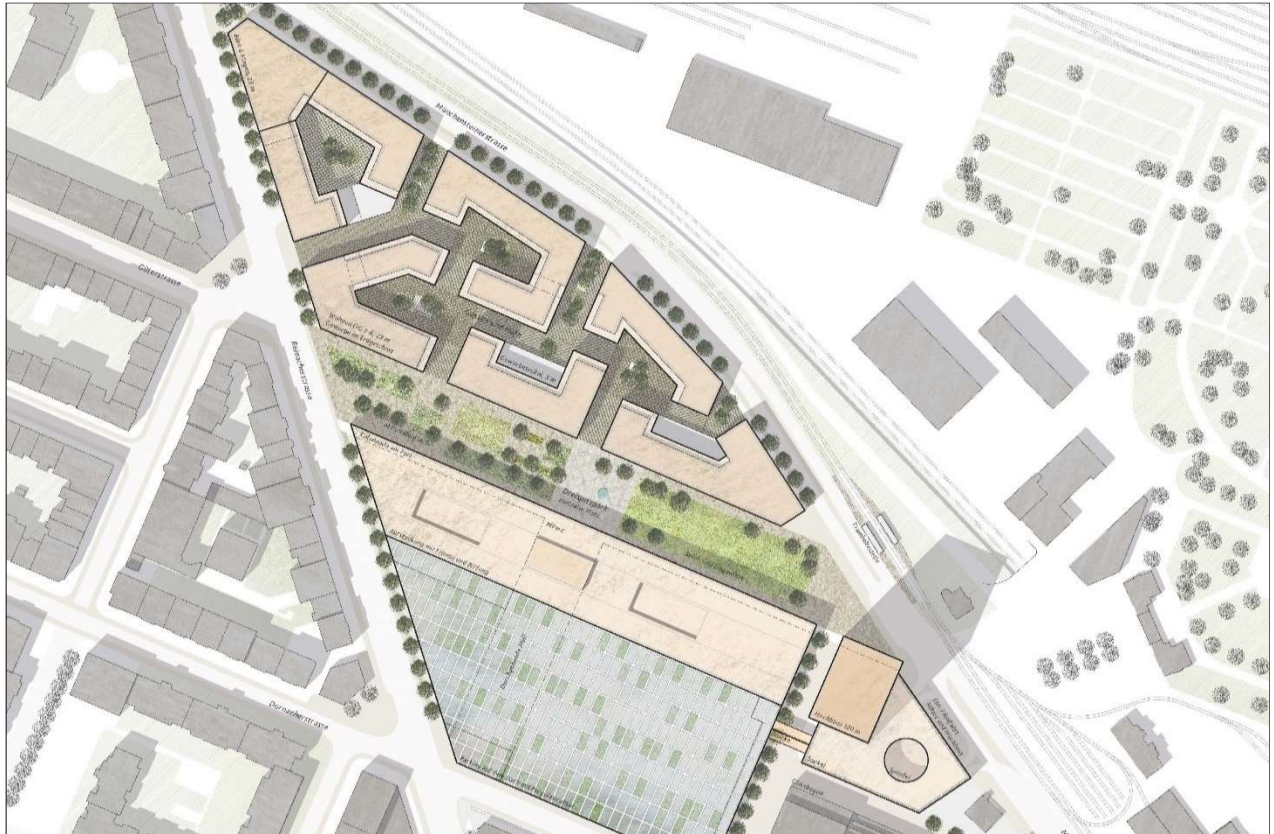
Vorschlag Baukontor. Situationsplan (Plan genordet, kein Massstab). Quelle: Baukontor
